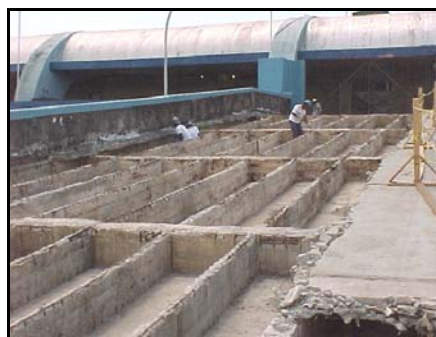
Danos e anomalias nas estruturas do vigamento de apoio após a demolição da laje superior.
